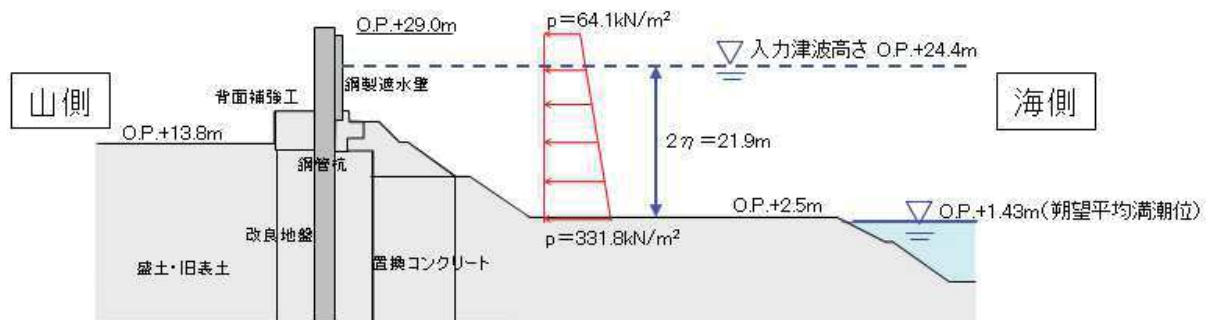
津波波圧設定の考え方（防潮堤（鋼管式鉛直式）の断面図）
